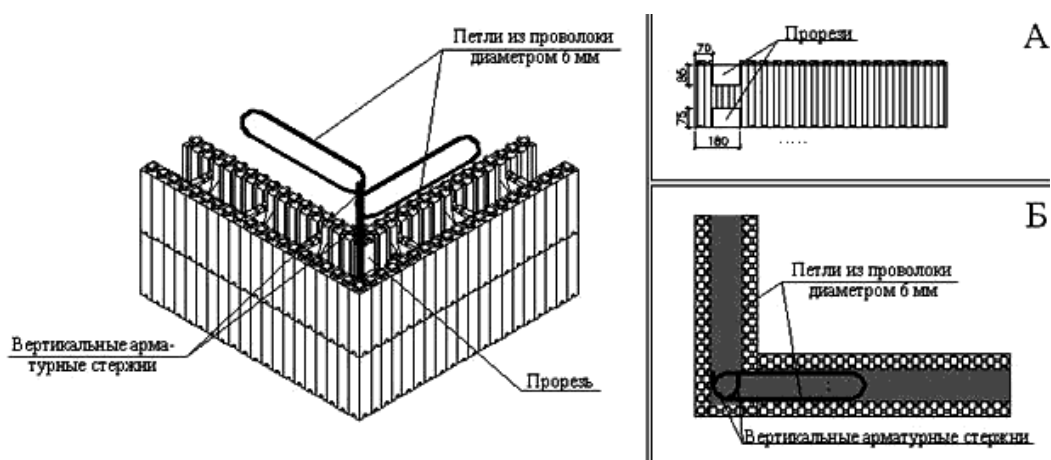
Конструкция угла наружной стены из пенополистирольных блоков
